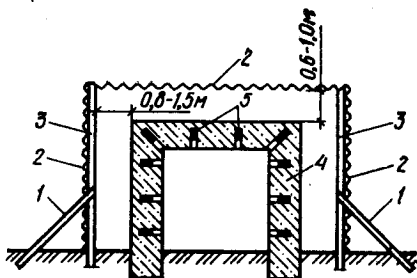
Схема укрытия бетонного тоннеля металлической сеткой для предотвращения разлета осколков:
